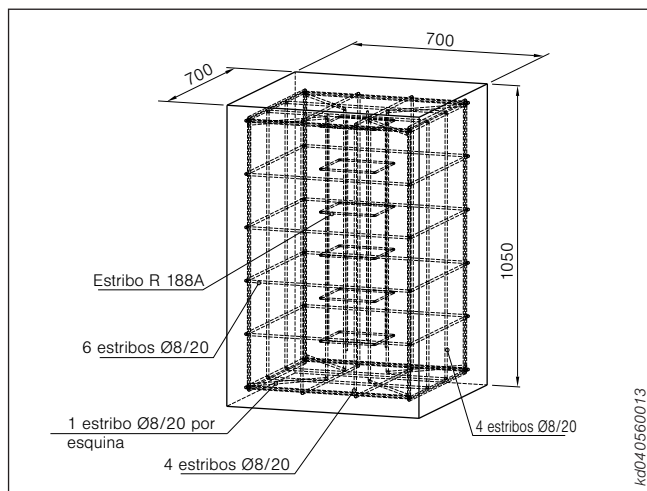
Cimientos de hormigón para montaje con soportes hormigonados
